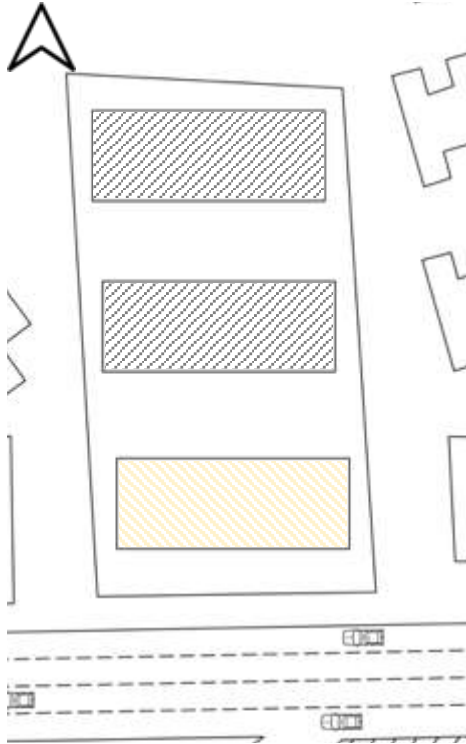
Zonificación planta baja de volúmenes en el sitio, etapa b.
